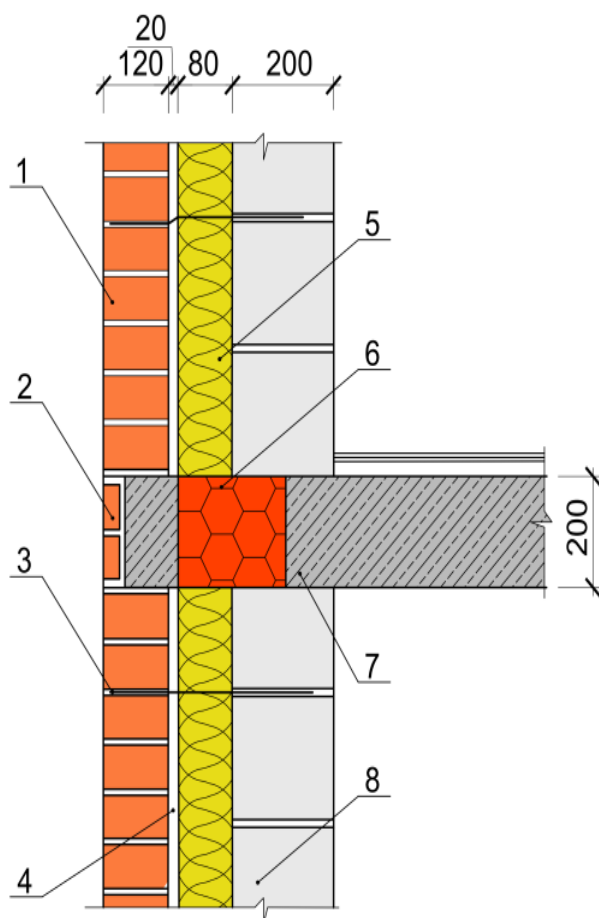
Конструктивный узел опирания плиты перекрытия: 1 – лицевой кирпич; 2 – доборный кирпич; 3 – гибкие связи; 4 – воздушный зазор; 5 – утеплитель; 6 – термовкладыш; 7 – монолитная железобетонная плита перекрытия; 8 – стеновые блоки
